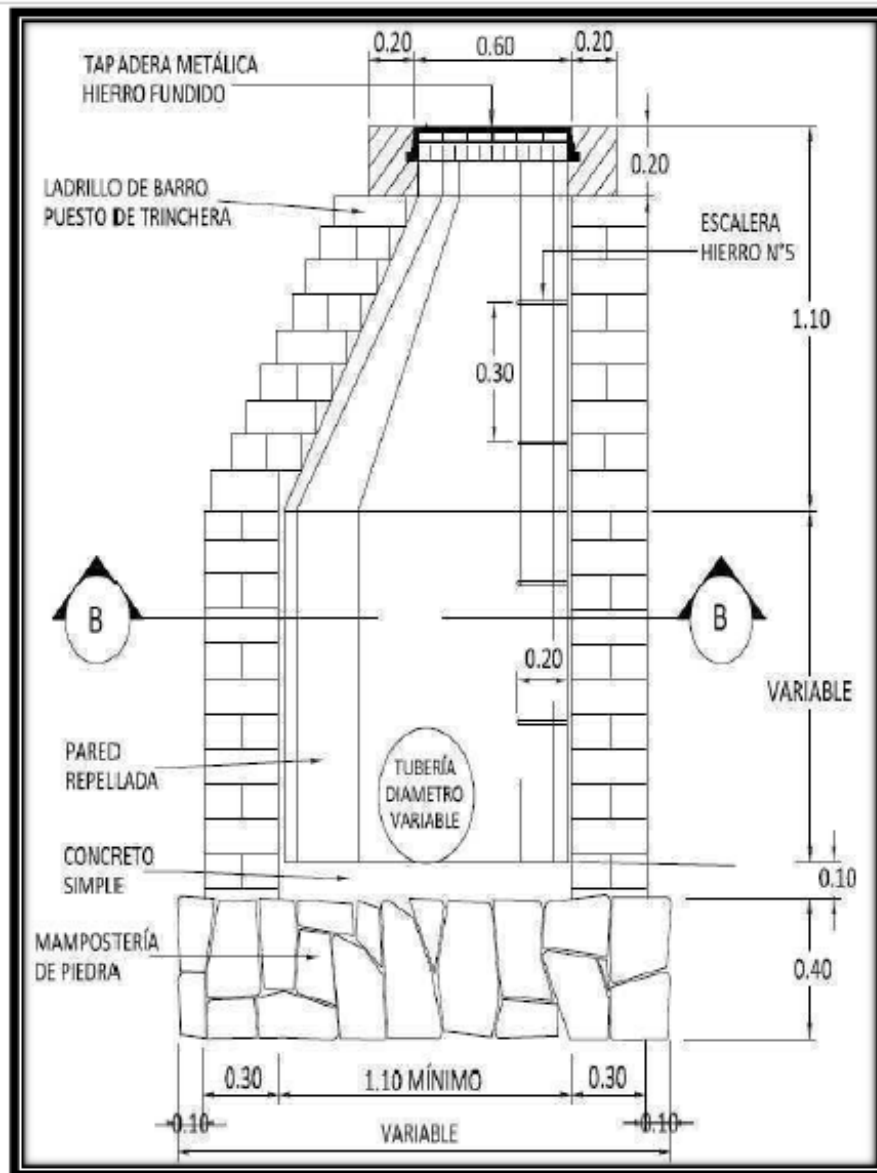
Vista de perfil de un pozo de visita. Fuente: Detalle típico de ubicación de tuberías en un derecho de vía.
